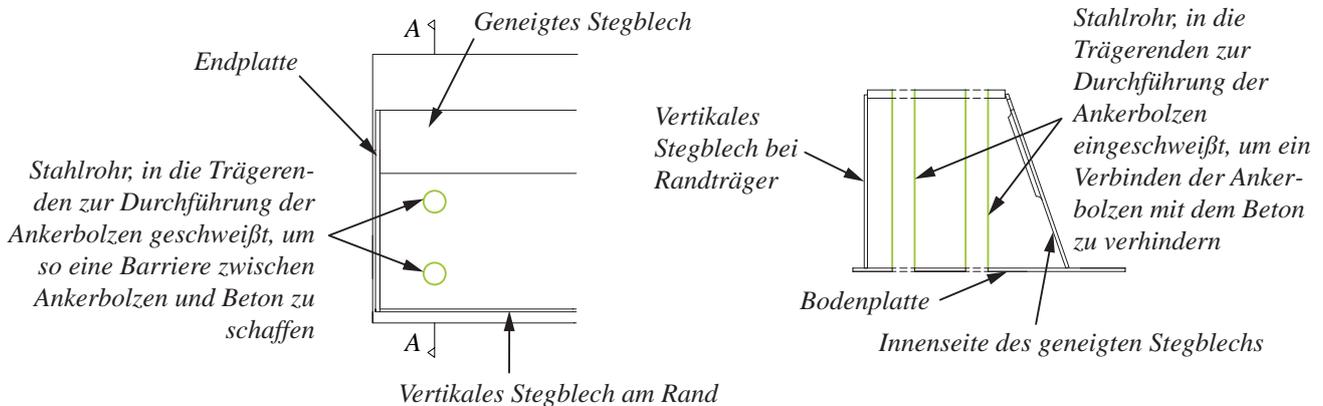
Detailansicht der Stahlrohre im Träger (Draufsicht, links). Detailansicht der Stahlrohre im Träger (Querschnitt, rechts)
